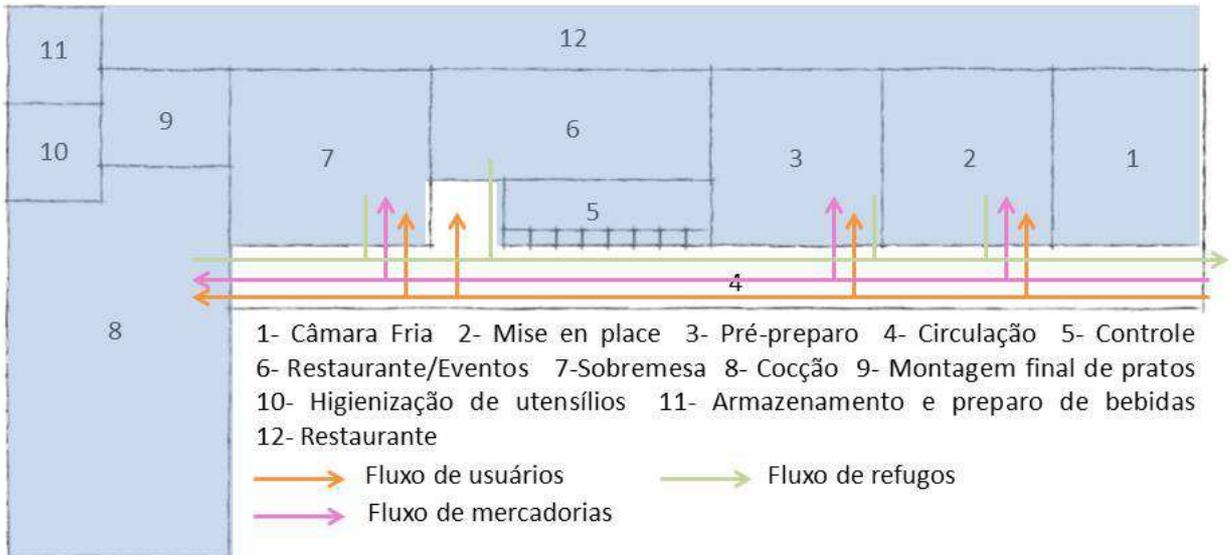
Planta do Restaurante-Escola do Senac-PR
